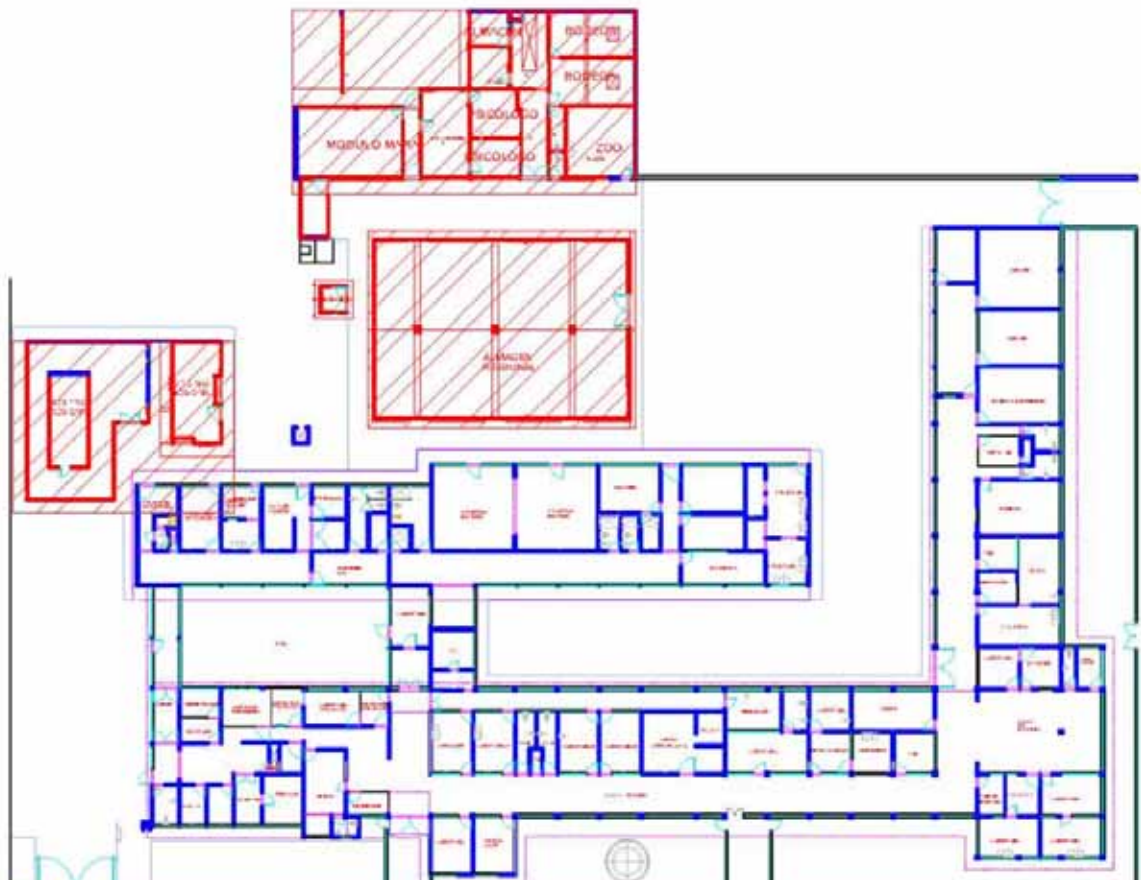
Planta Arquitectónica. Del Centro de Salud de Zitácuaro 03-02-2020. Fuente: secretaria de Salud 2020.
